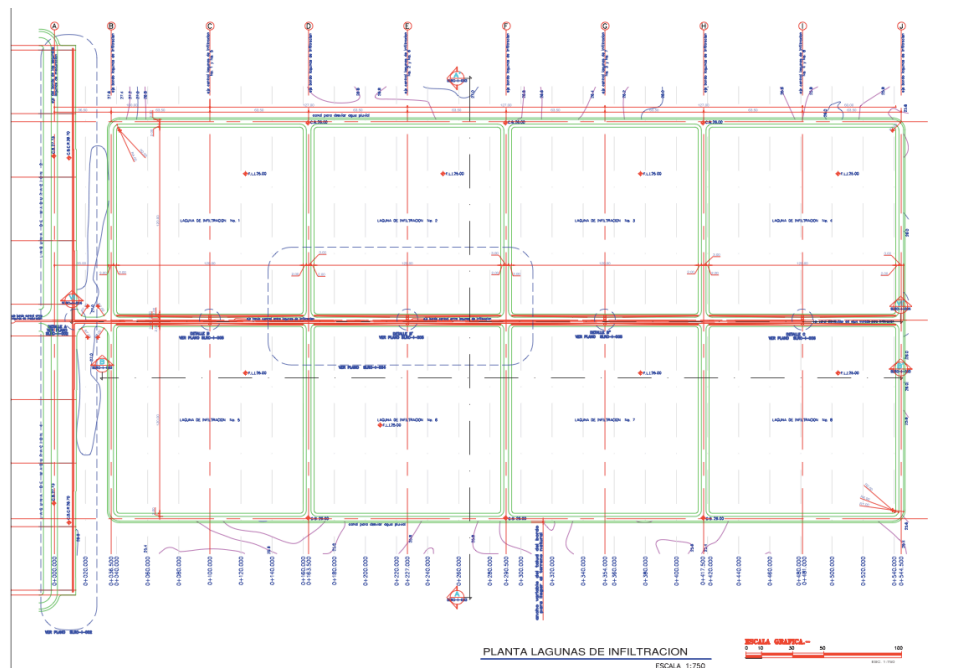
Arreglo de las lagunas de infiltración, San Luís Río Colorado. Fuente: (Hernández, 2009).
